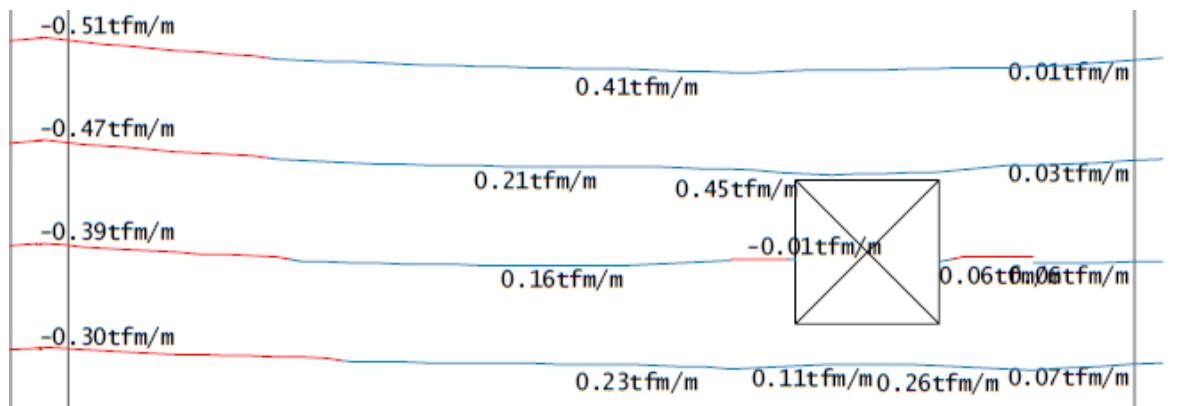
Armaduras negativas horizontais e verticais para a laje LA 50/50-02.
